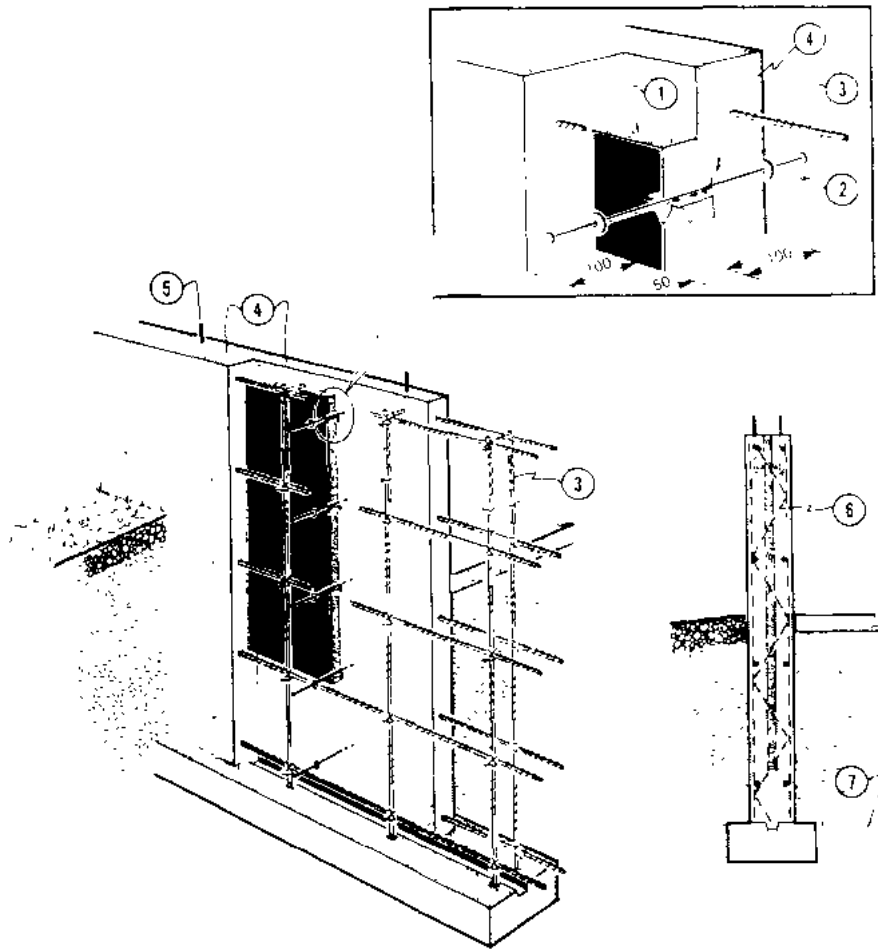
防鼠农场建筑的隔热混凝土夹层地基的现场浇筑。周围的隔热层①完全能包埋在钢筋混凝土预制板中,以防止鼠类侵入(参见“计划 M-9451”)
